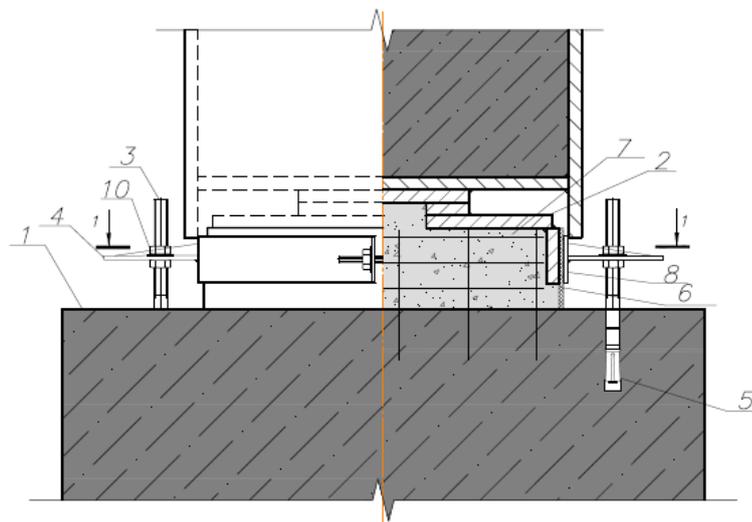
Разрез по нижнему шарнирному узлу анкерного крепления трубобетонной опоры к монолитному железобетонному фундаменту
